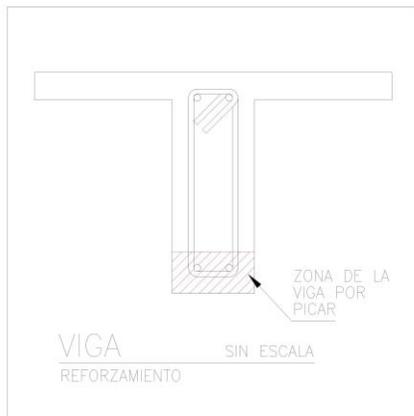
Pica de viga para reforzamiento. Autocad 2005.
